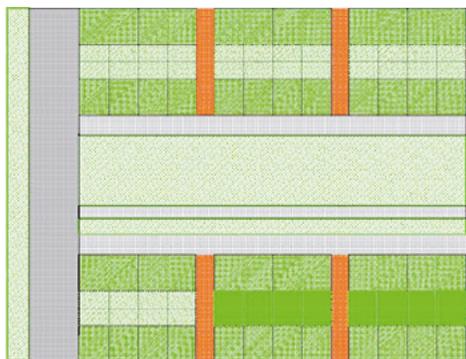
Ejemplo de planta de viviendas unifamiliares.
